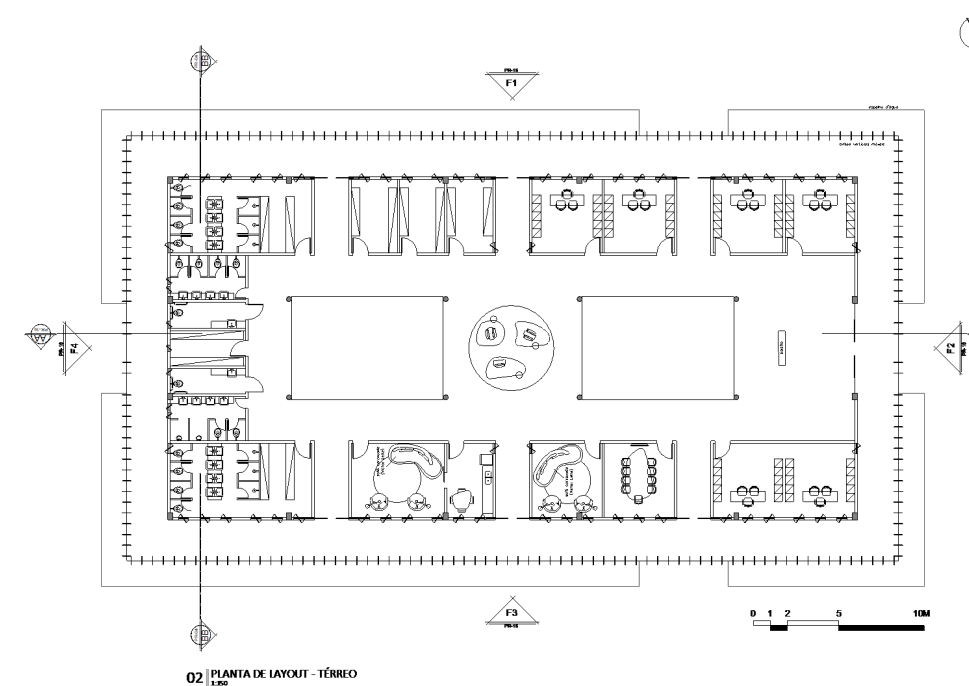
Planta baixa térreo do bloco administrativo e de serviço. Elaborada pela autora, 2022.
